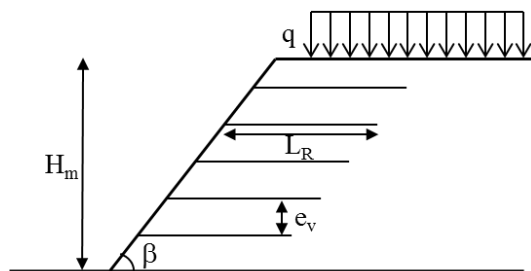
Perfil transversal genérico das estruturas dimensionadas
